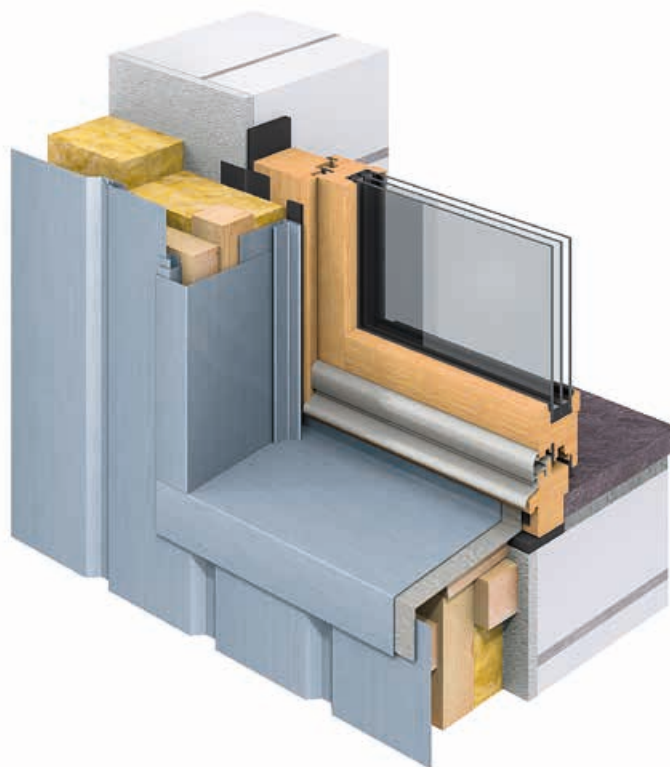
união de parapeito de janela a fachada com RHEINZINK-SP-LINE
